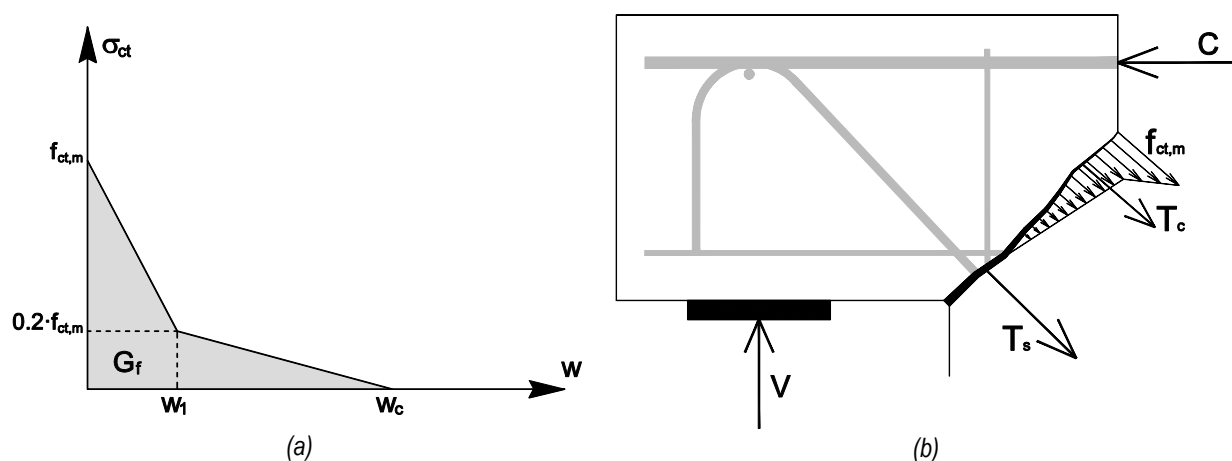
(a) Ley de *softening* en la fisura propuesta por MC-2010 [13]; (b) Esquema simplificado tracciones en el hormigón
